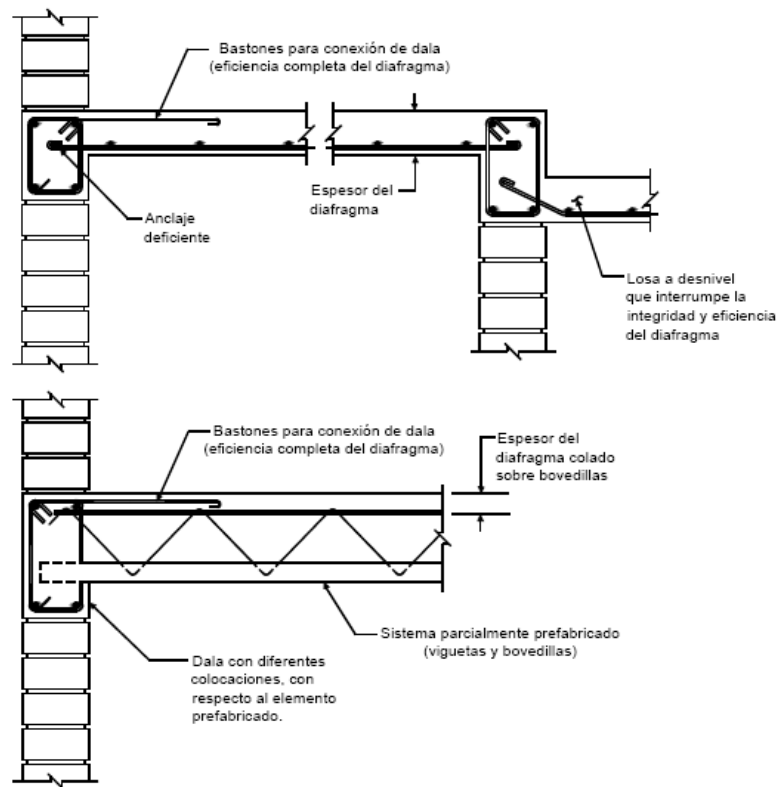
Detalles y recomendaciones constructivas (fuente: SMIE, 2003; 85)
